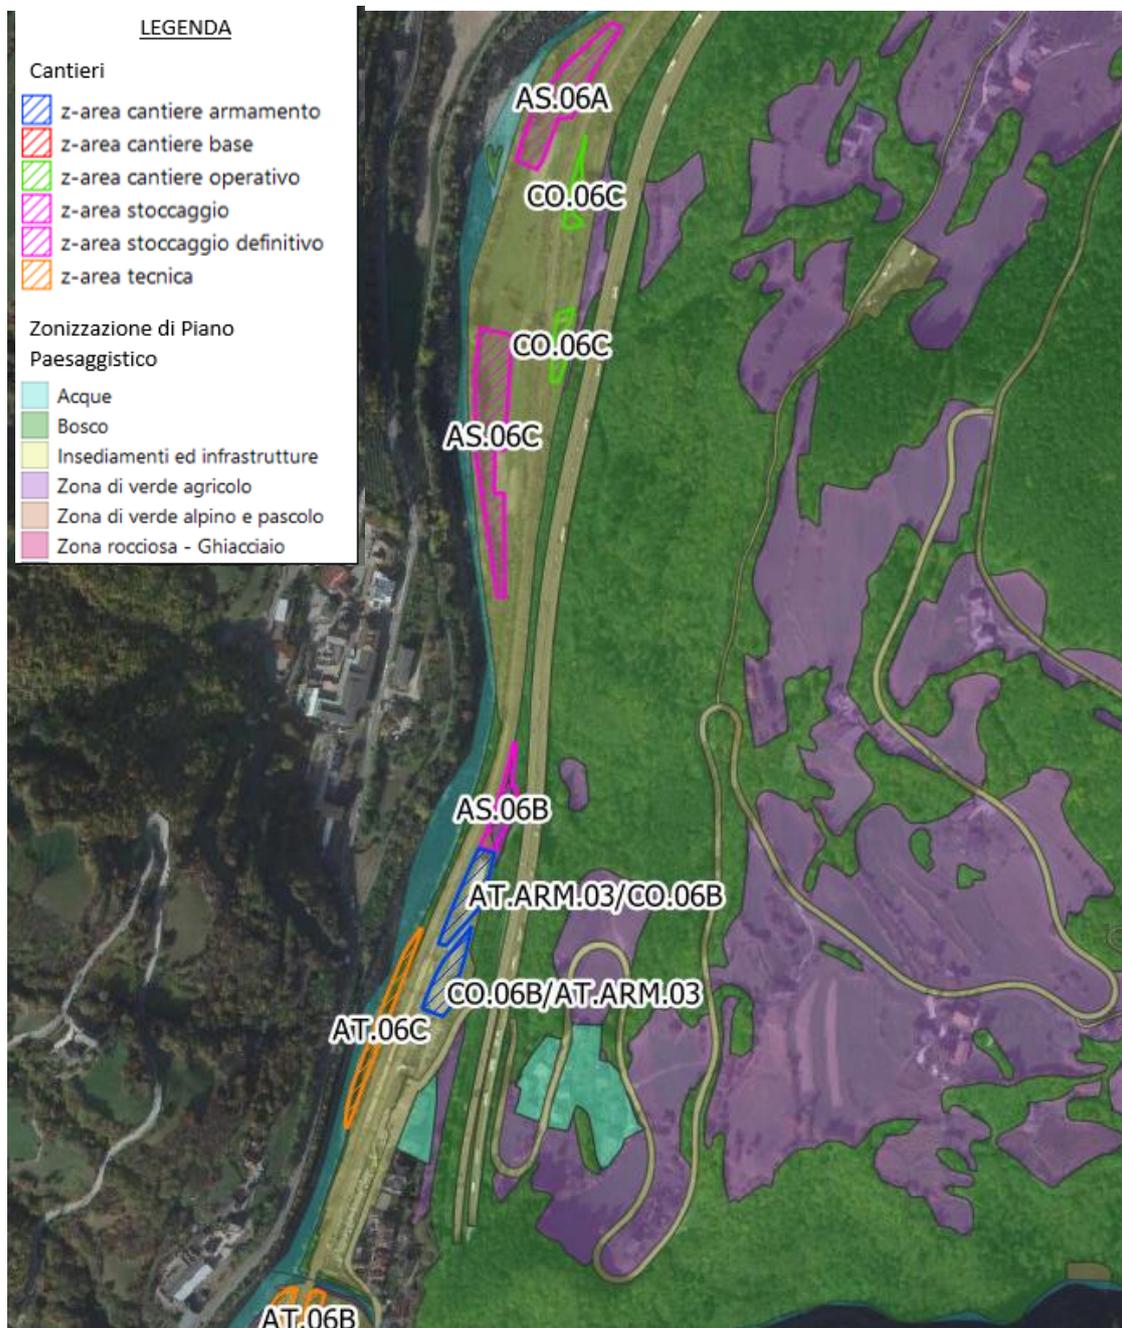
Individuazione delle aree di cantiere dell'ambito Ponte Gardena con relativa zonizzazione di Piano – Progetto Esecutivo
